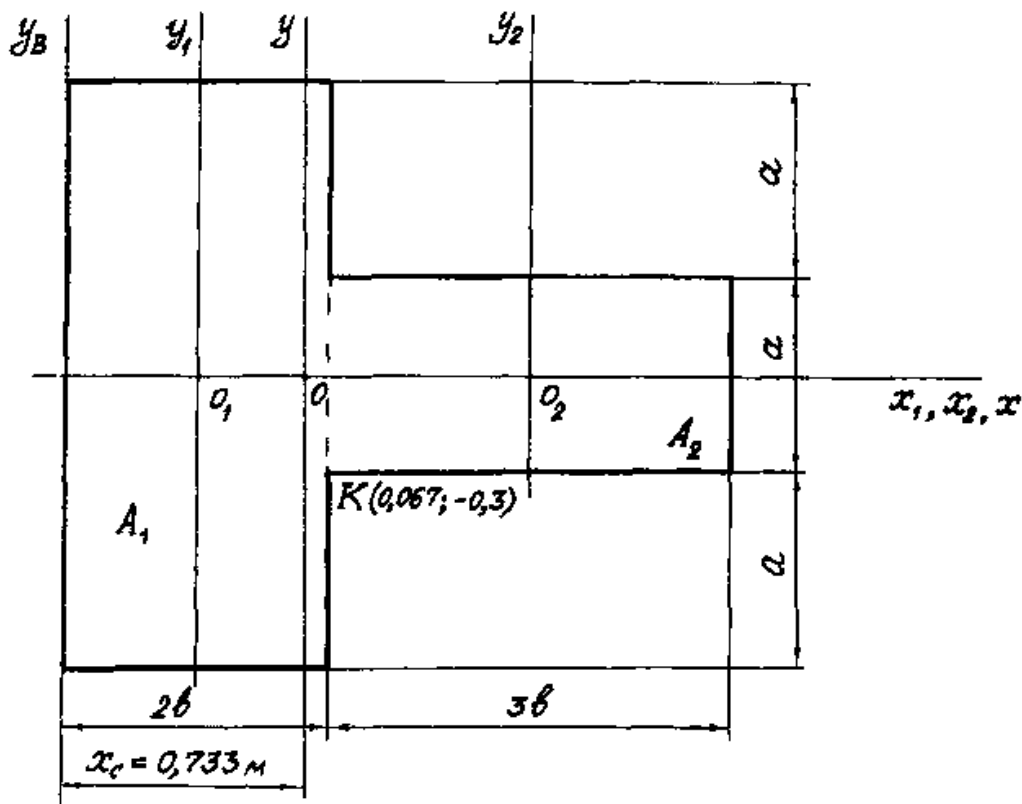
Геометрична схема поперечного перерізу стержня
